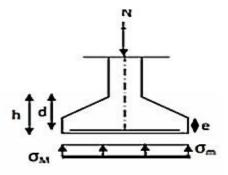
Diagramme des contraintes agissant sur les fondations
